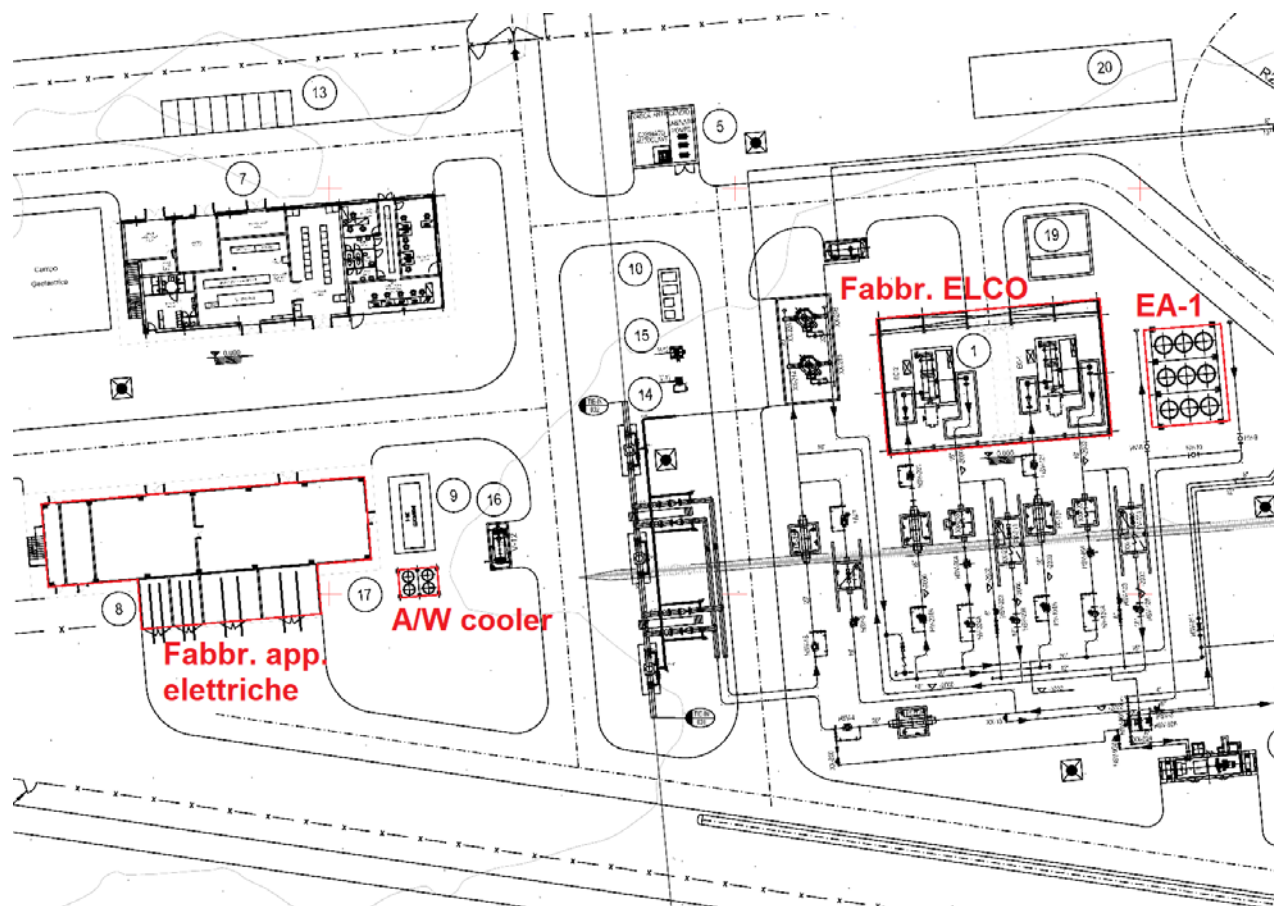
Stralcio della planimetria della stazione di spinta con la localizzazione delle sorgenti rumorose continue esaminate (in rosso).
